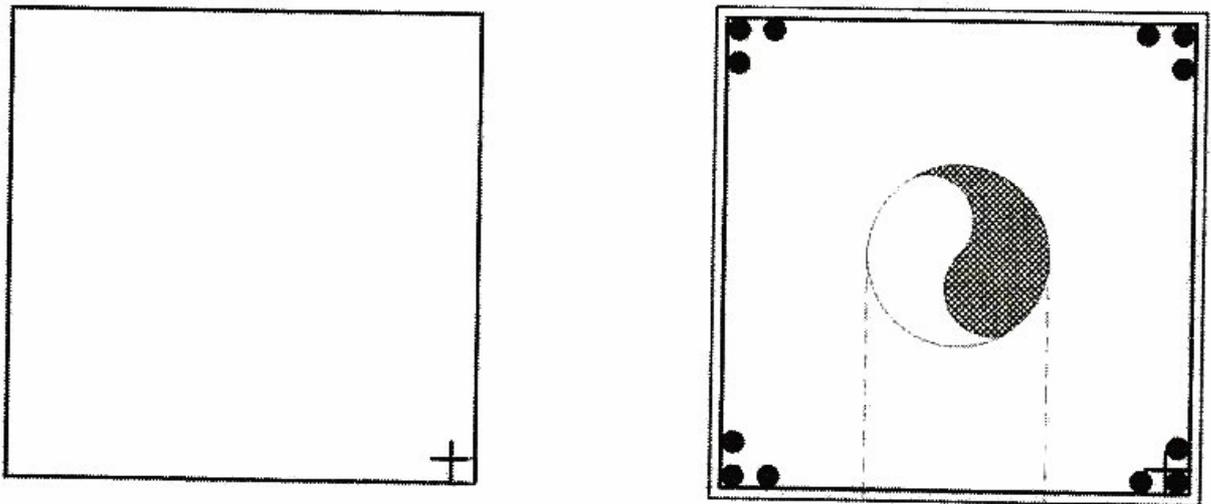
Exemplo de posicionamento de armadura no pilar.
